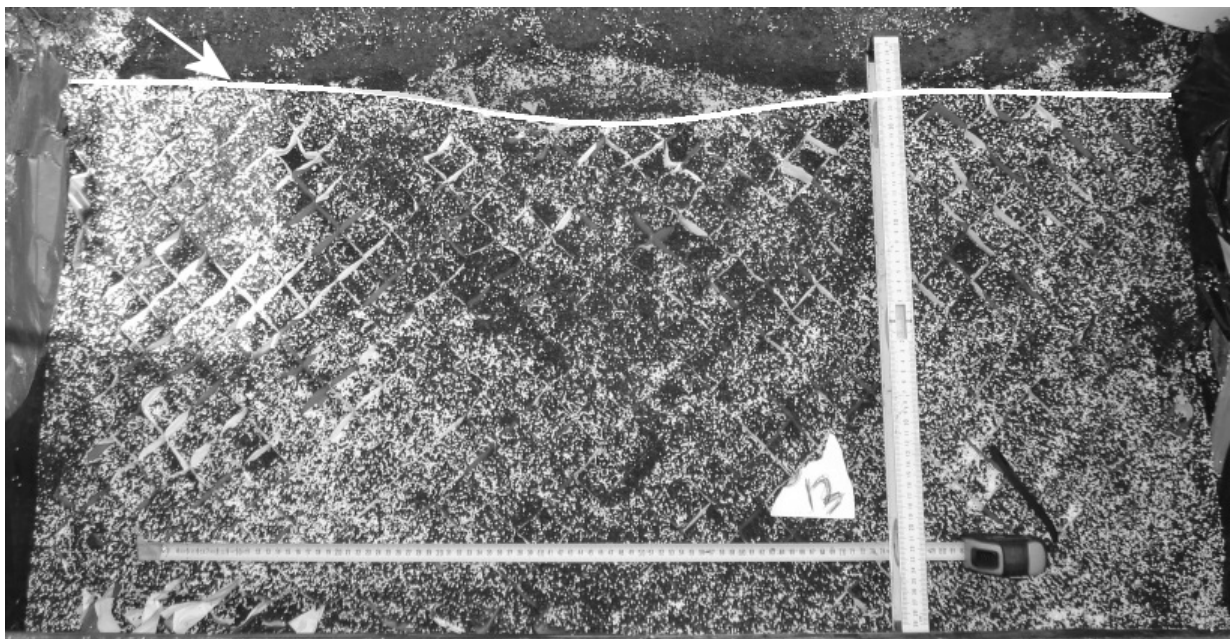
Effet de membrane d'un lit d'alvéoles situé dans le plan horizontal d'impact (ouvrage plastique)
